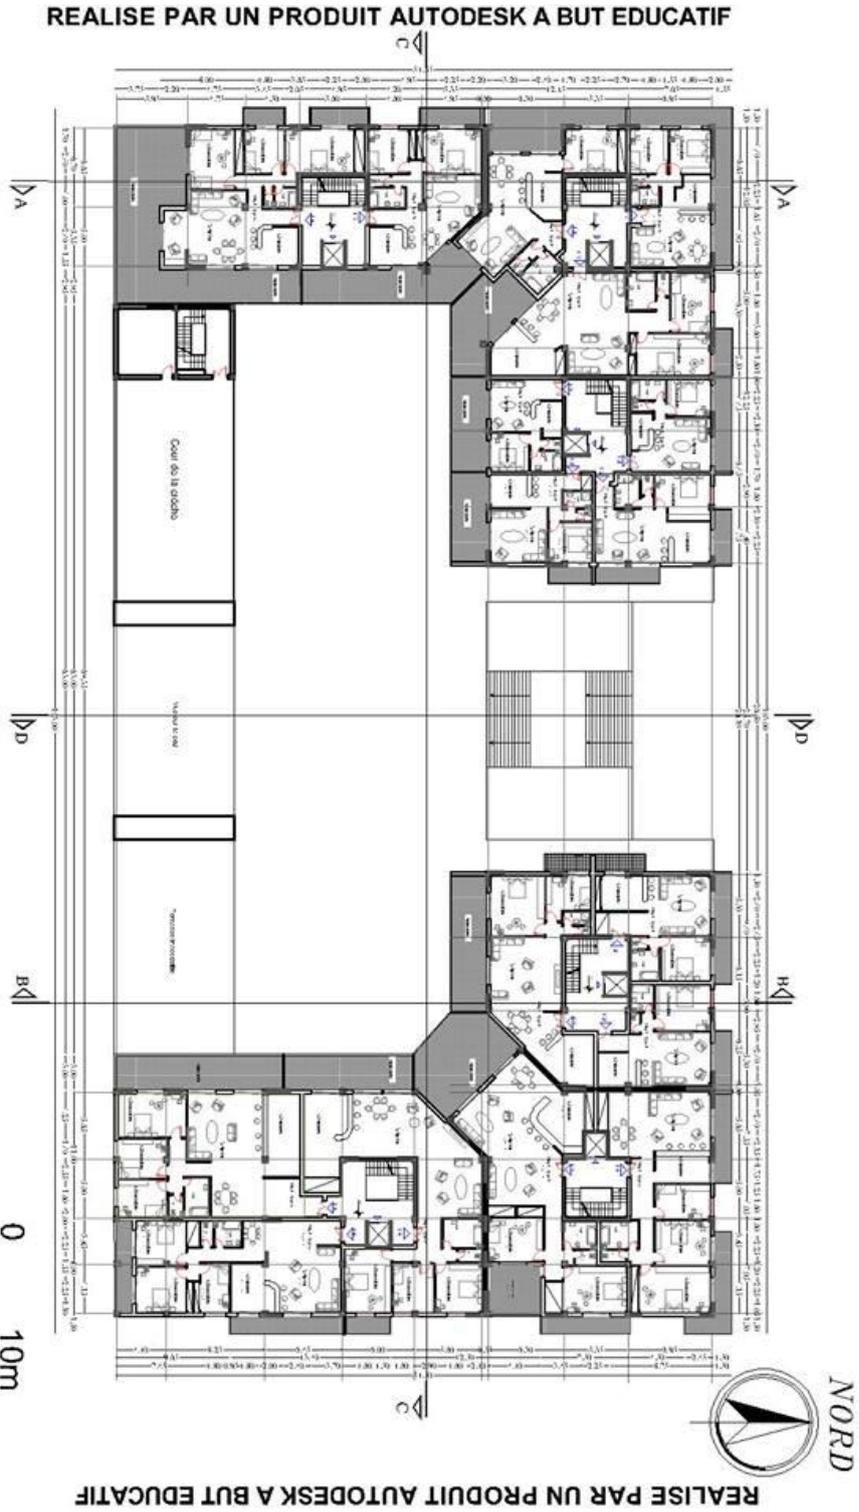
Plan 2ème étage « Cour , Bureaux ;Equipement »
